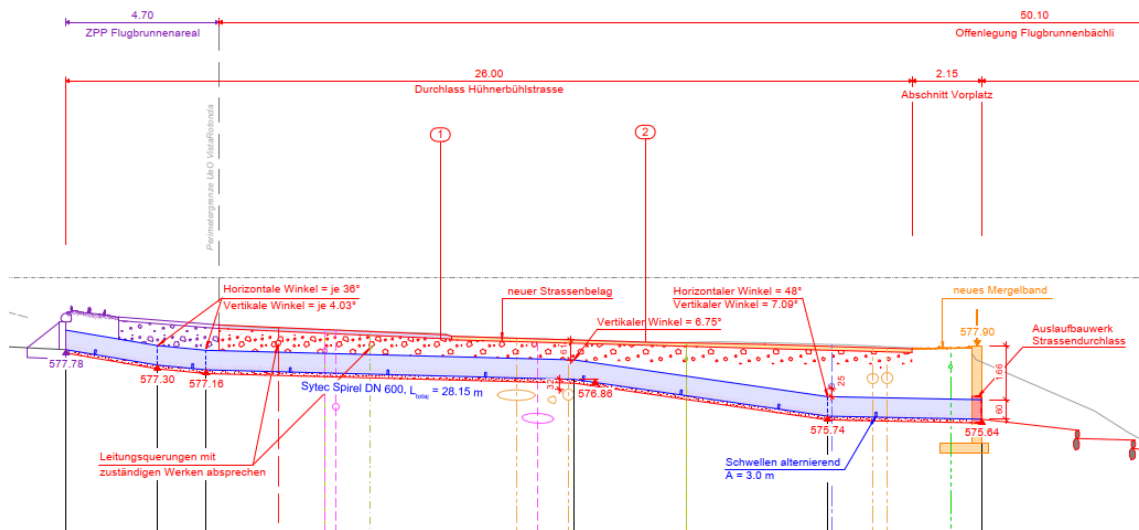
Längsprofil des Bachdurchlasses im Bereich der Querung der Hühnerbühlstrasse. Mehrere Gefällsknicke, um Konflikte mit den bestehenden Werkleitungen zu vermeiden (siehe Plan 33.621).
